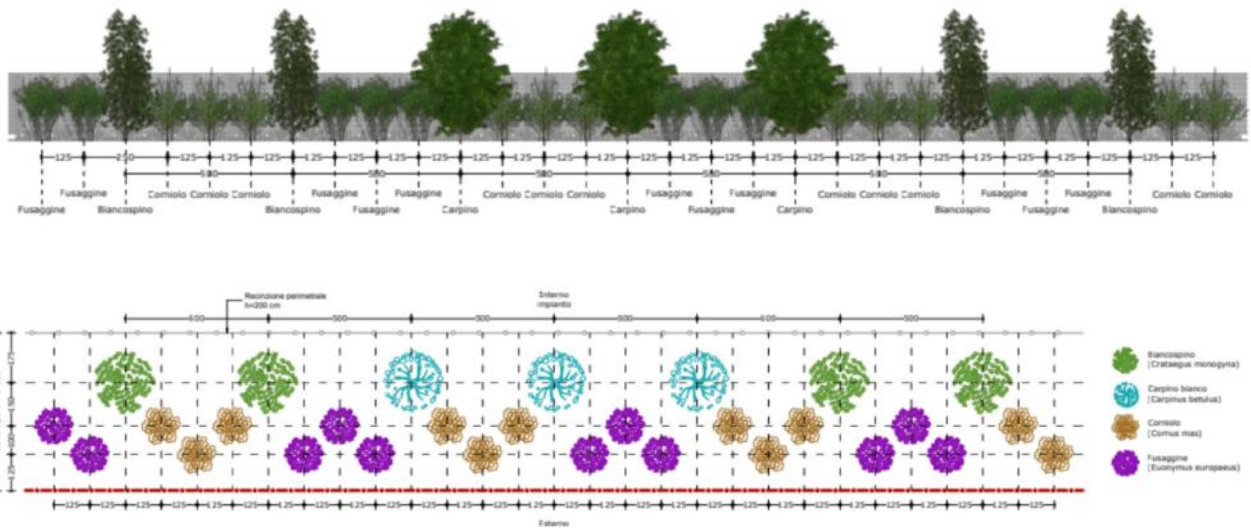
Pianta e prospetto della mitigazione di tipo 3 (da elab. di progetto)
